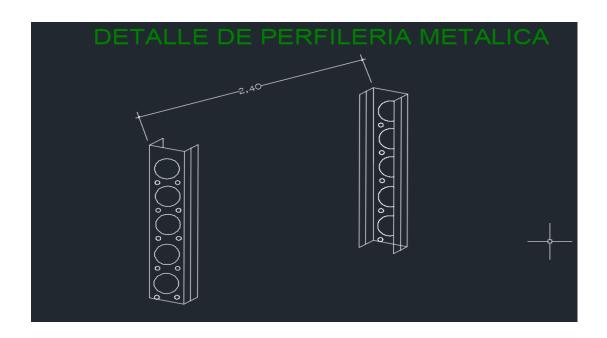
detalle de cálculo Aislapanel Fuente: Kevin Ronald Armas Padilla
